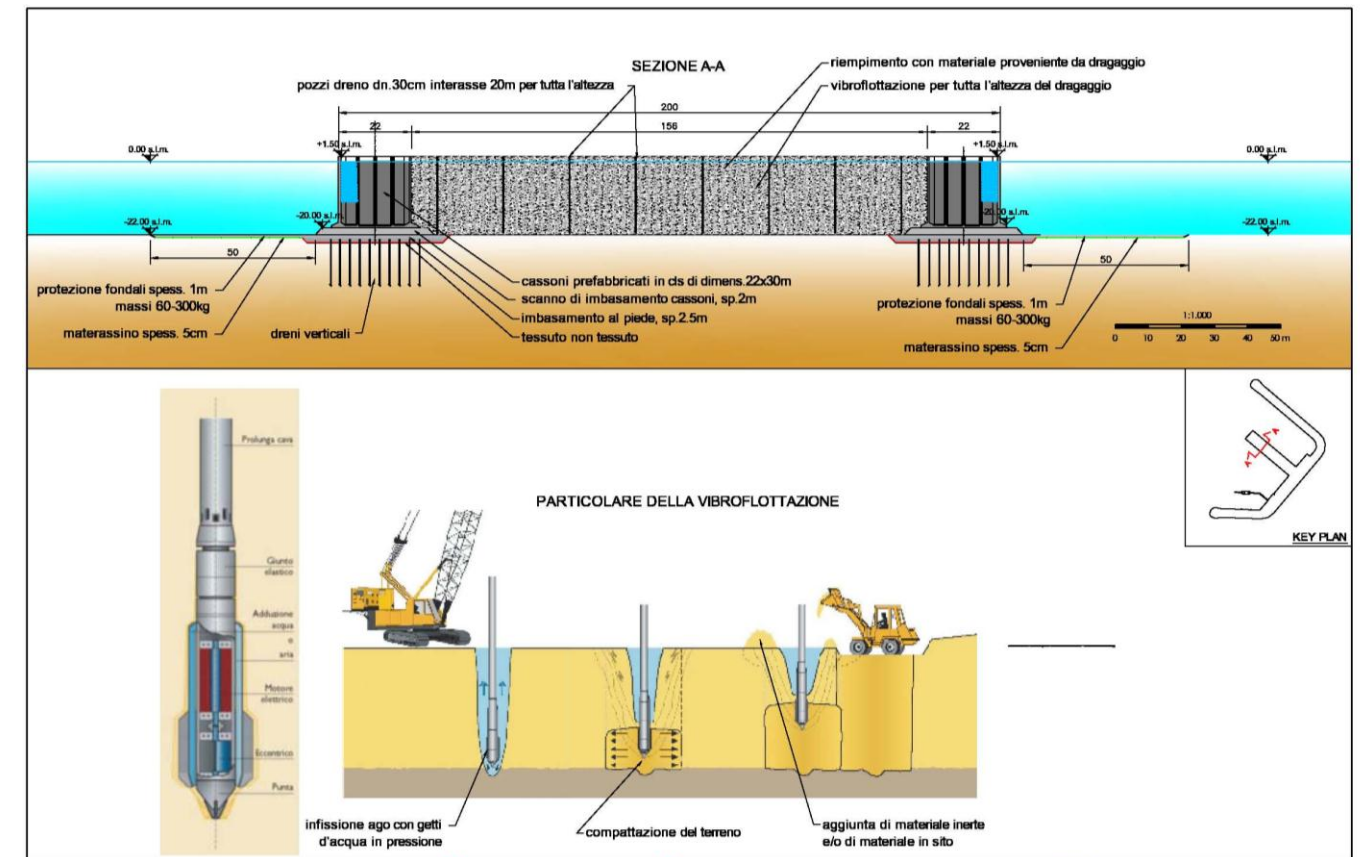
Banchina containers – vibroflottazione del terrapieno di riempimento
